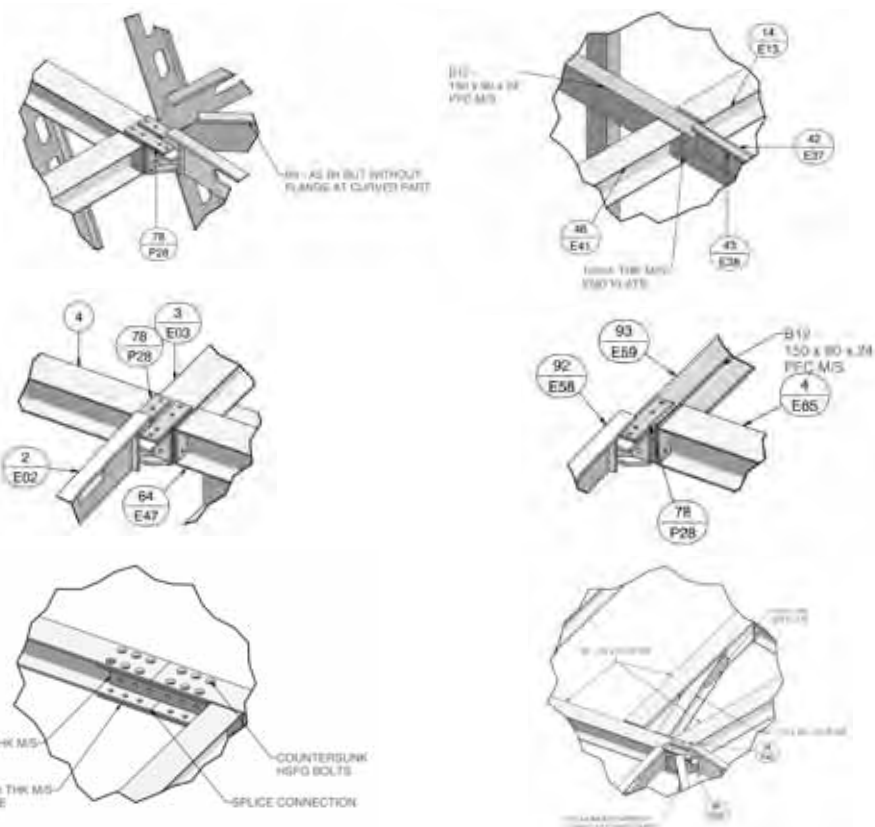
\_ Detailpunkte- Westliches Gebäude © Boundary Metal LTD
